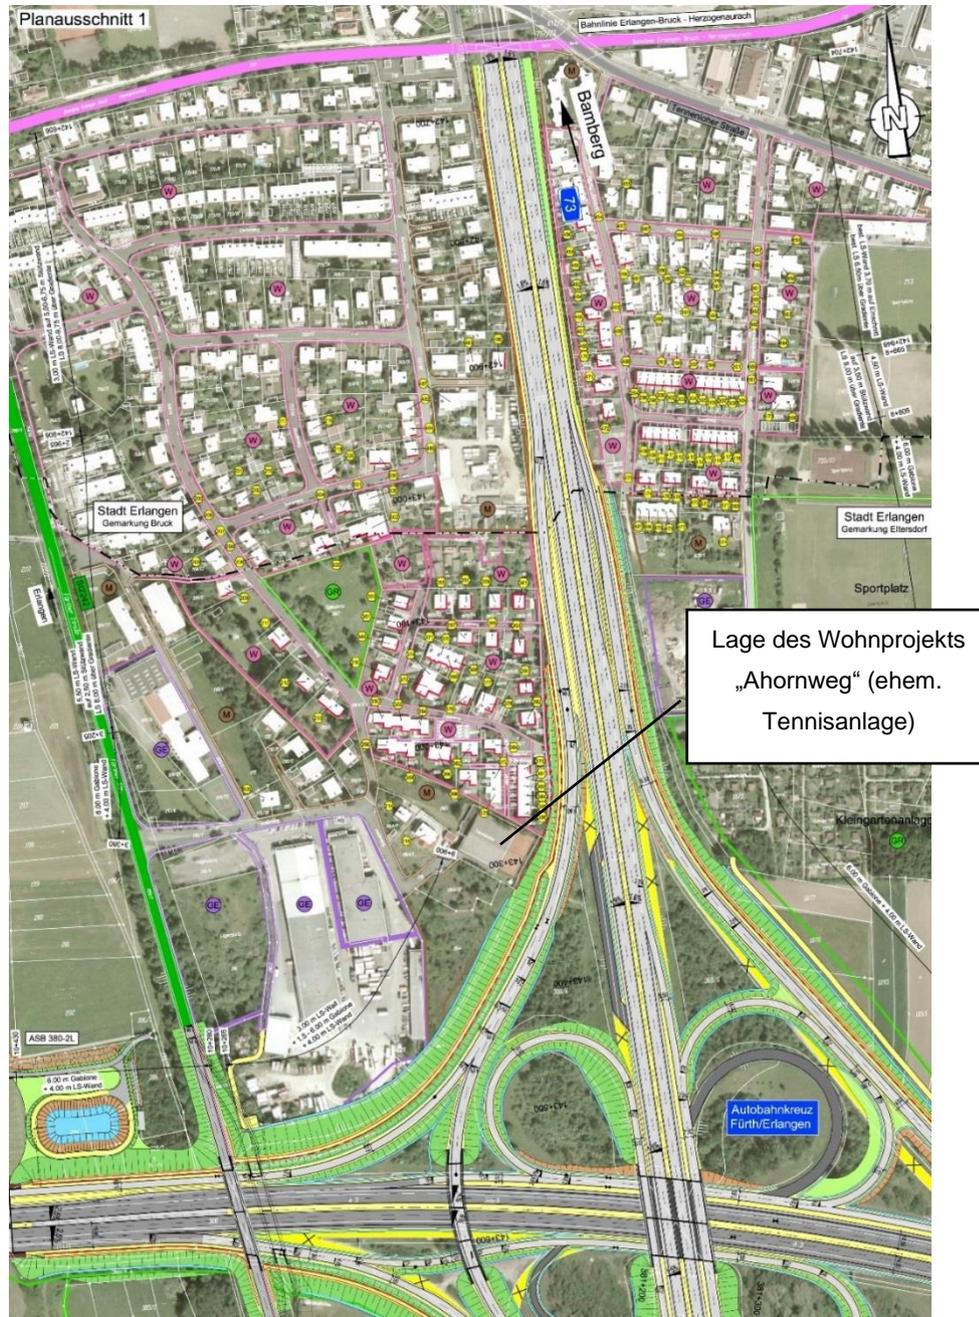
Ausbau des AK Fürth / Erlangen, Ausschnitt des Lageplans zum geplanten Lärmschutz /5/
